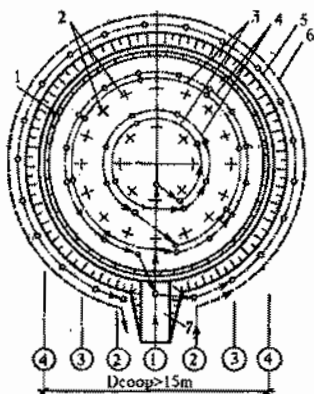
Принципиальная схема монтажа крупного цилиндрического резервуара: 1 - стеновые панели; 2 - места установки колонны; 3 - ось движения крана при монтаже колонны; 4 - то же, при укладке ригелей и плит покрытия; 5 - то же, стеновых панелей и плит покрытия по следнего ряда; 6 - ось движения транспортных средств; 7 - въезд и выезд из котлована; кружками обозначены стоянки крана
